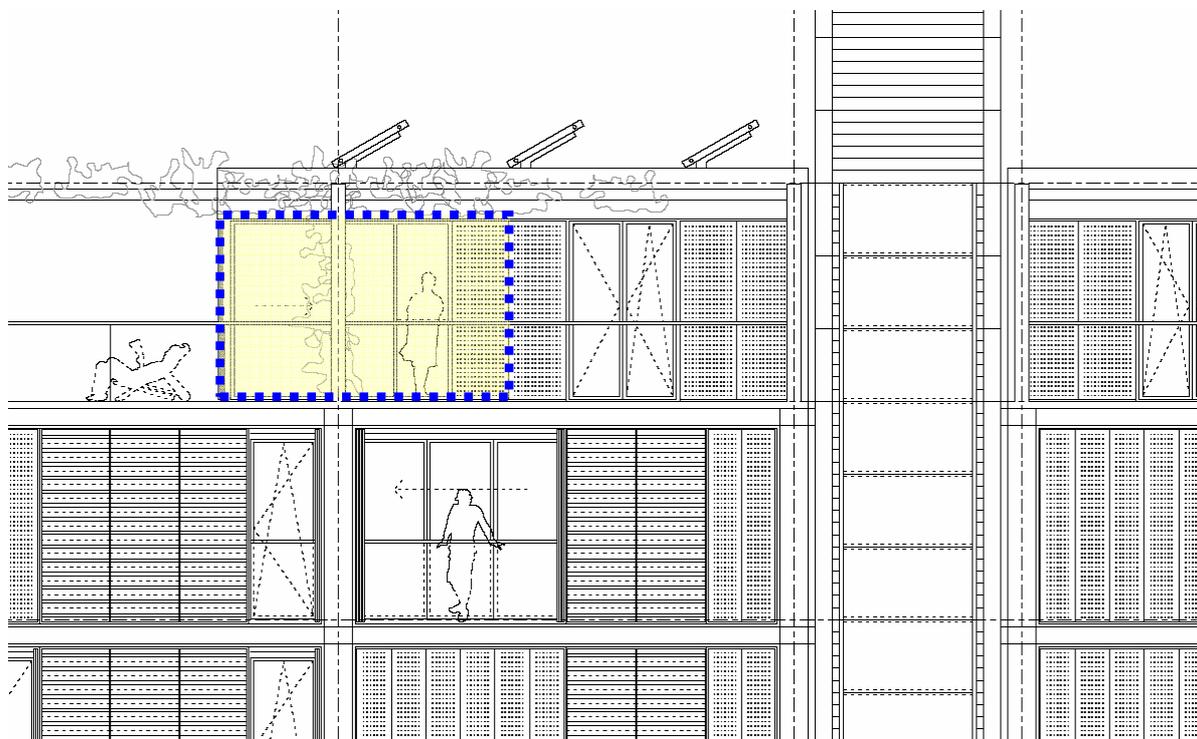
Indicazione in prospetto della facciata oggetto di valutazione
